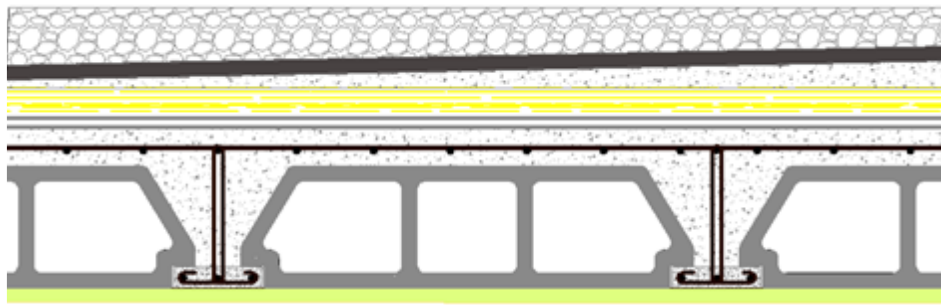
Composants d'un plancher terrasse en corps creux.
